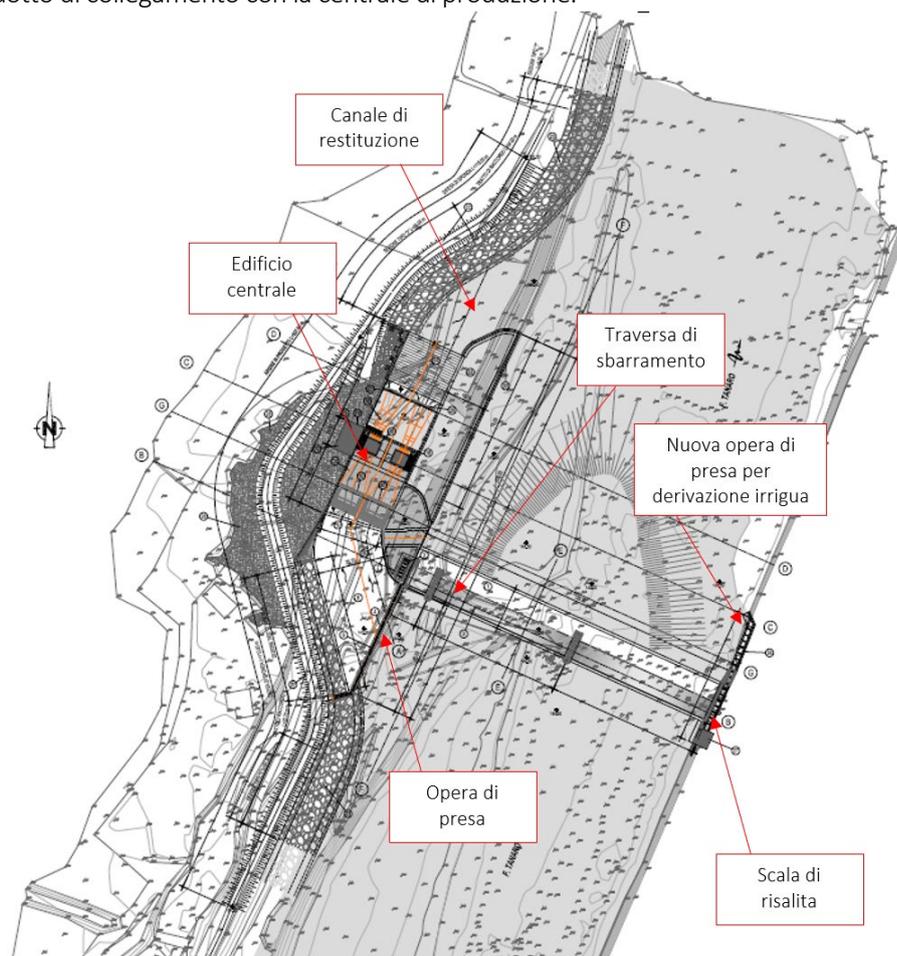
Estratto dell'Elab. 4 – Planimetria di progetto (dicembre 2013)
